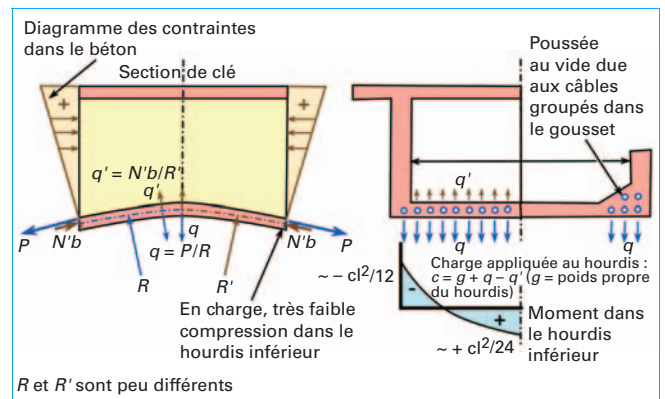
Poussée au vide générale dans le hourdis inférieur d'une poutre-caisson
